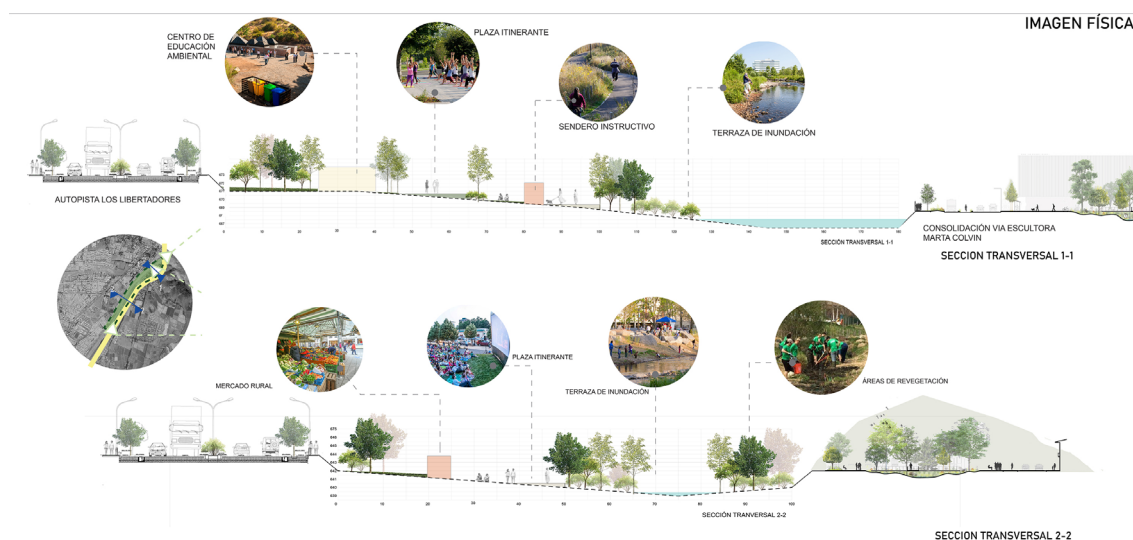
Secciones transversales del proyecto. Fuente: Elaboración propia
